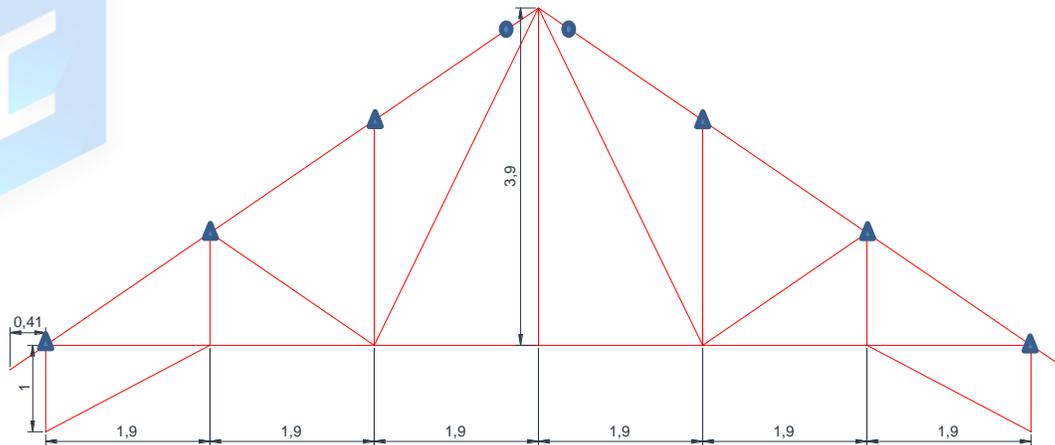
Cerchas principales de la cubierta del bloque B4: museo – Bellas Artes.
